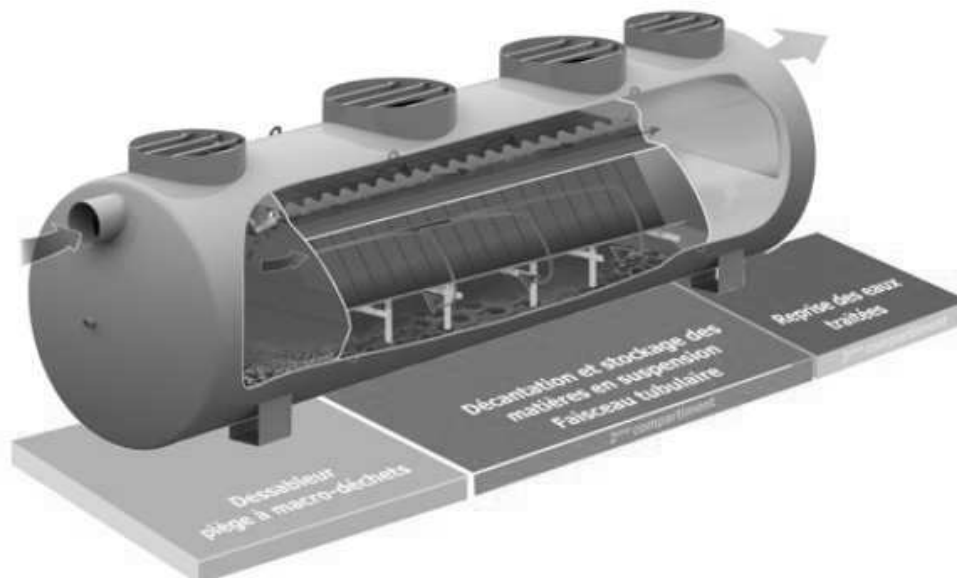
Schéma type d'un décanteur (source : Techneau, 2016)
